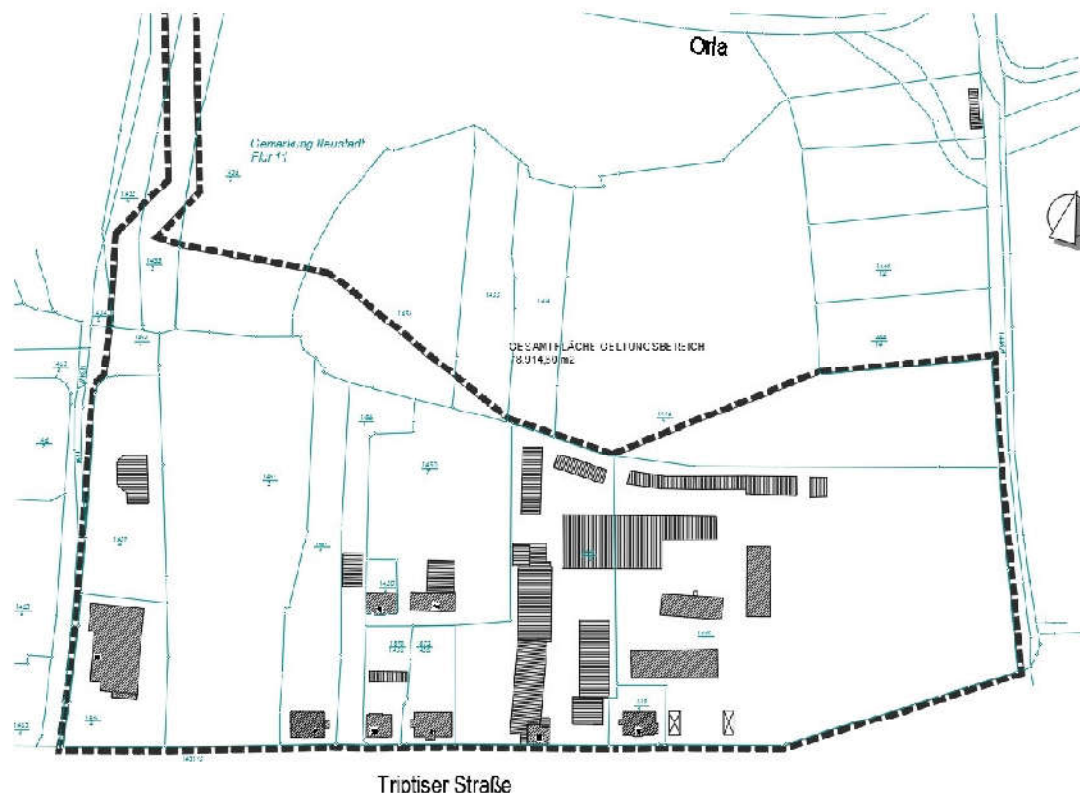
Übersichtslageplan Geltungsbereich und Gebäudebestand
